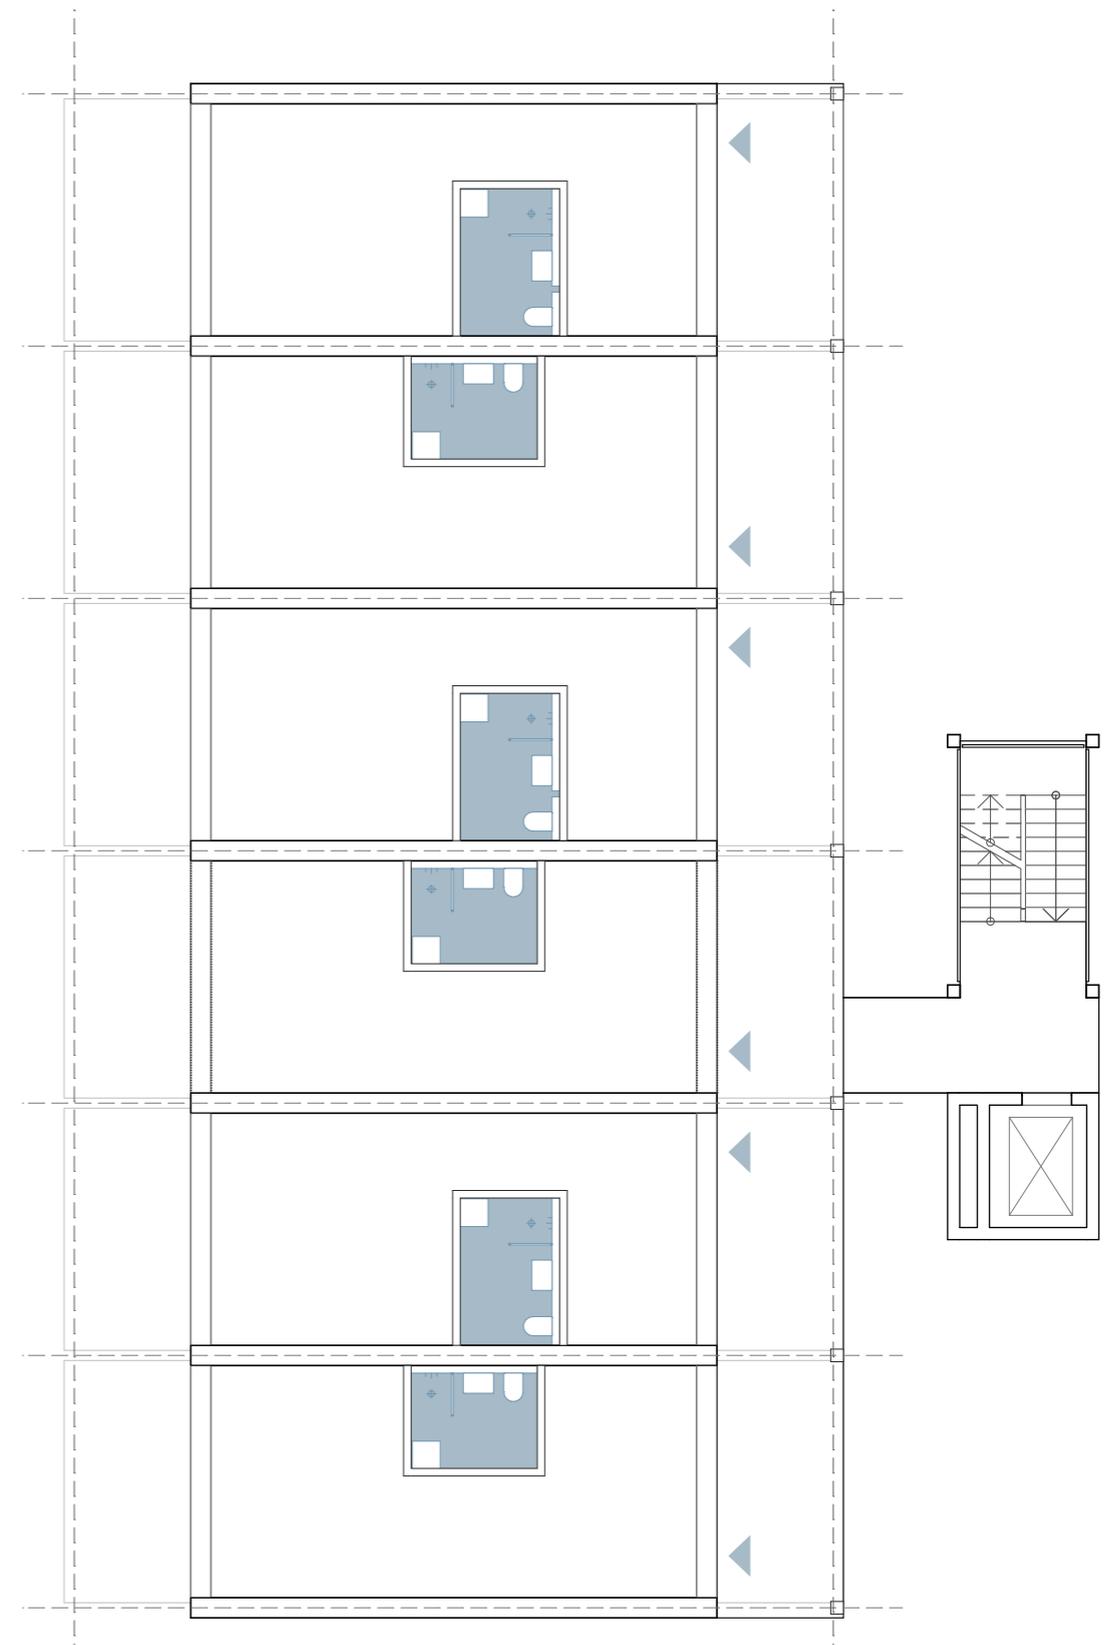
Schematischer Grundriss Funktion Wohnen
